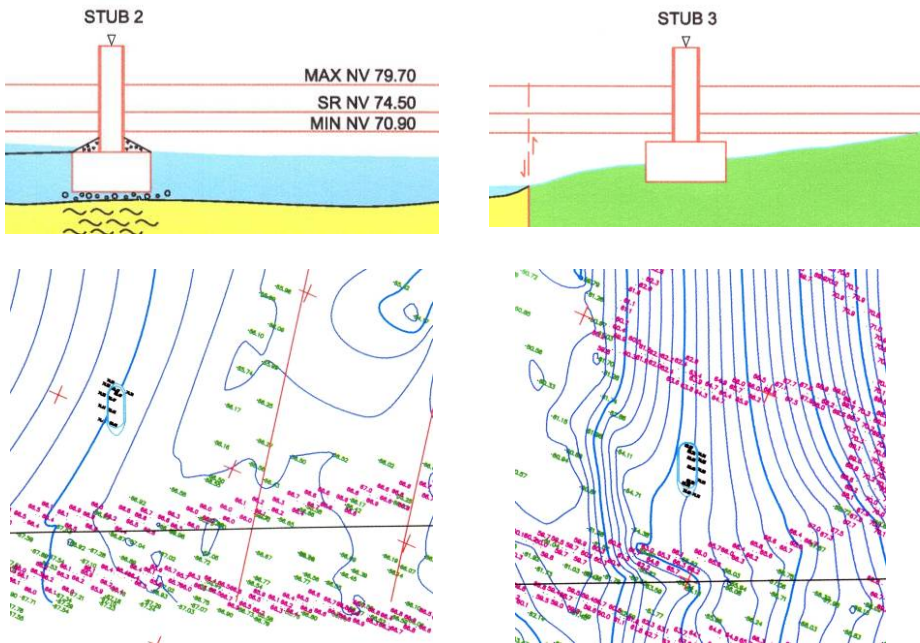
Cross section of terrain in the bridge zone (*Poprečni presek terena u zoni mosta*)
